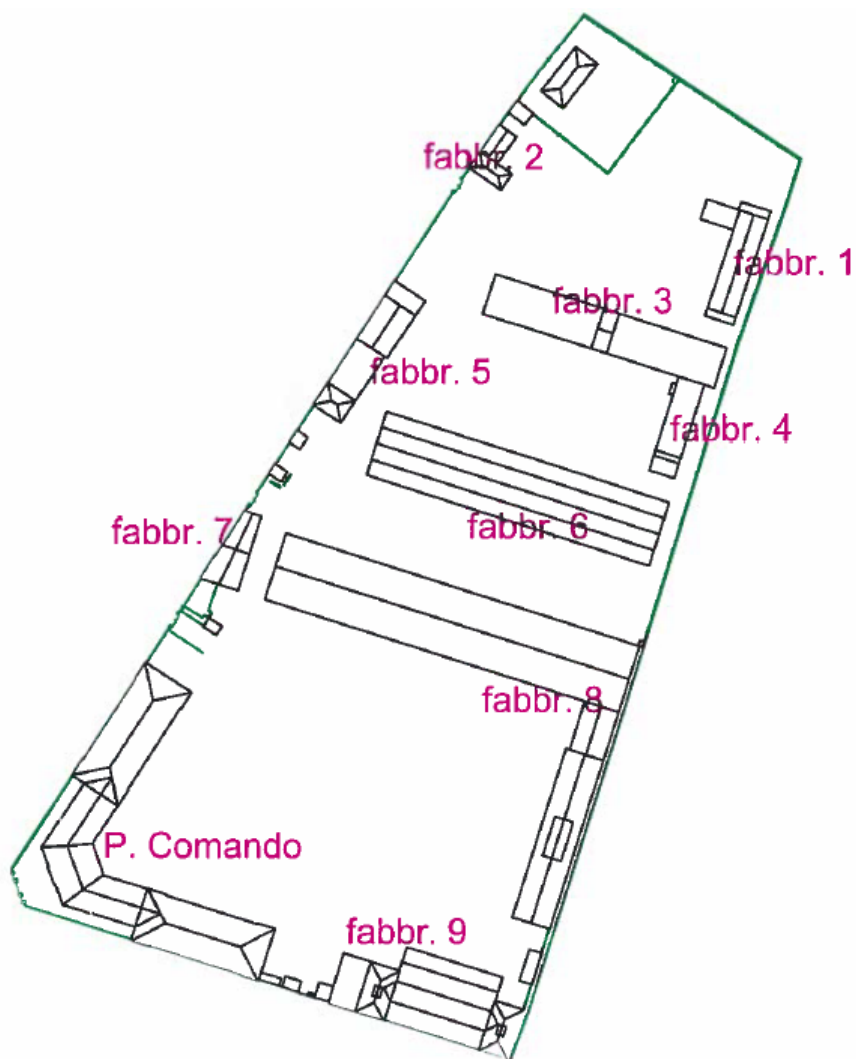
Schema planimetrico dello stato di fatto del compendio edilizio
